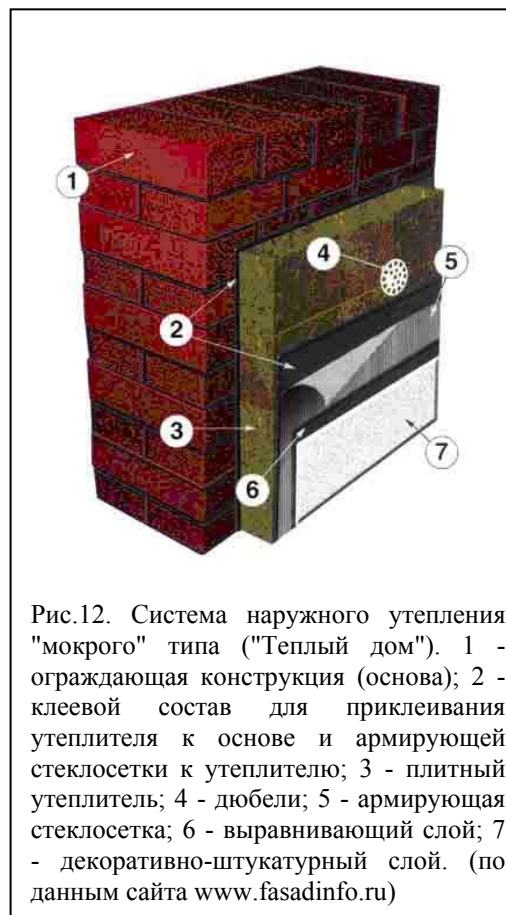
Система наружного утепления "мокрого" типа ("Теплый дом"). 1 - ограждающая конструкция (основа); 2 - клеевой состав для приклеивания утеплителя к основе и армирующей стеклосетки к утеплителю; 3 - плитный утеплитель; 4 - дюбели; 5 - армирующая стеклосетка; 6 - выравнивающий слой; 7 - декоративно-штукатурный слой. (по данным сайта www.fasadinfo.ru)
